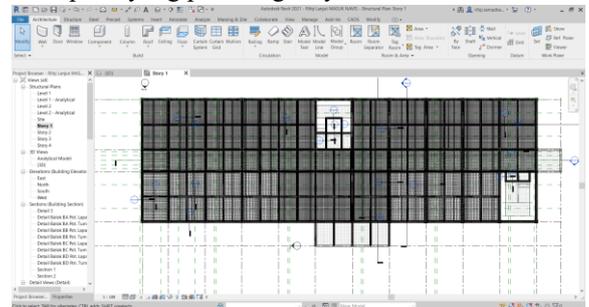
Desain Penulangan Balok Revit 2021 ii. Penulangan Kolom
